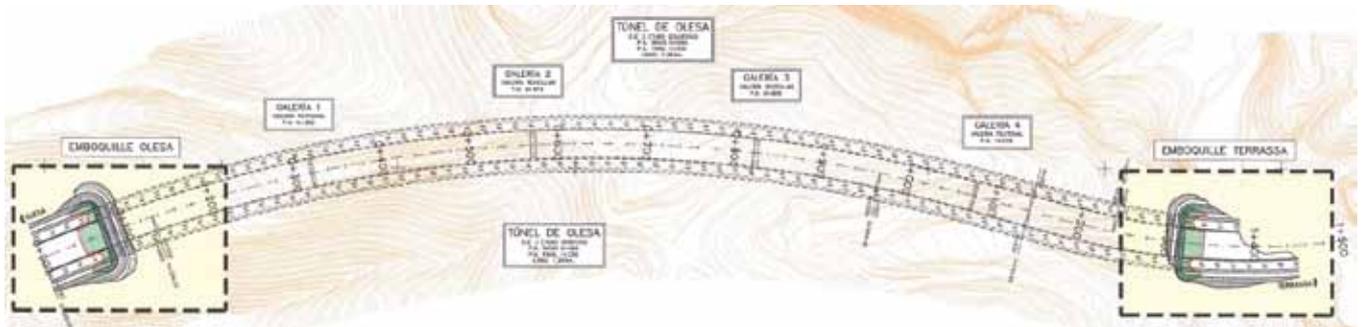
Planta general del Túnel de Olesa (autovía B-40)
